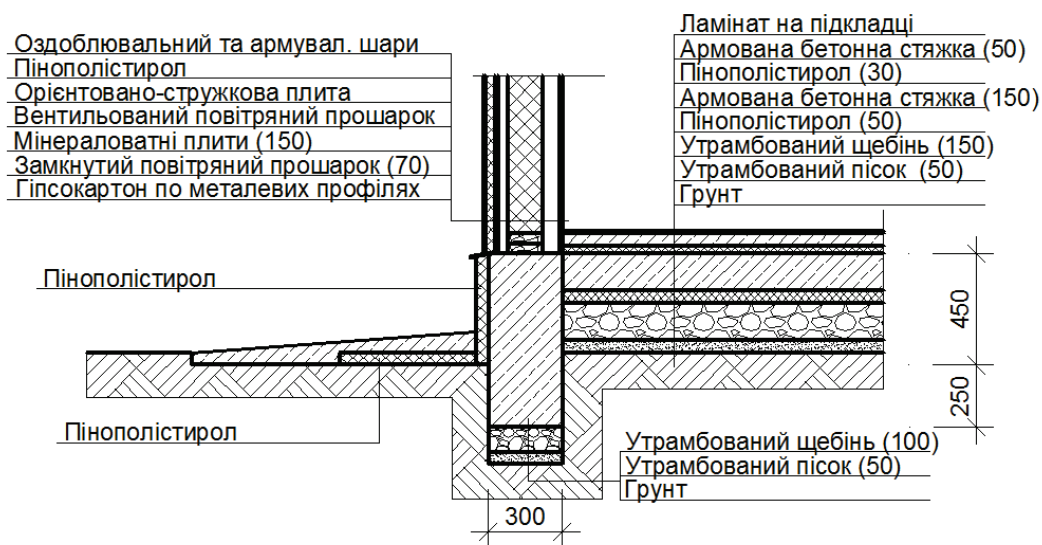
Вузол опирання зовнішньої стіни на фундамент
